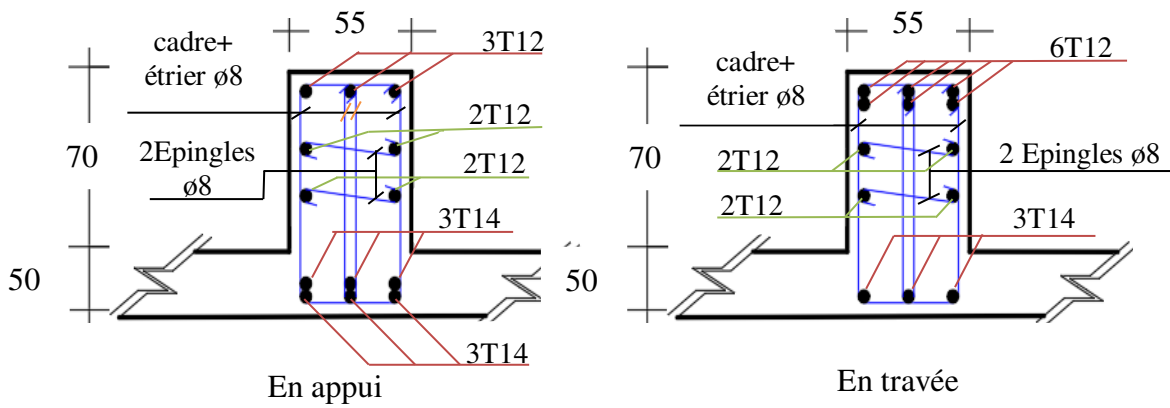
Ferrailage de la poutre secondaire en travée et en appui.
